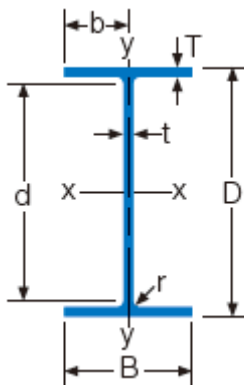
Balok induk elemen frame 1969 yang berlokasi di lantai 7 elevasi + 25.90
